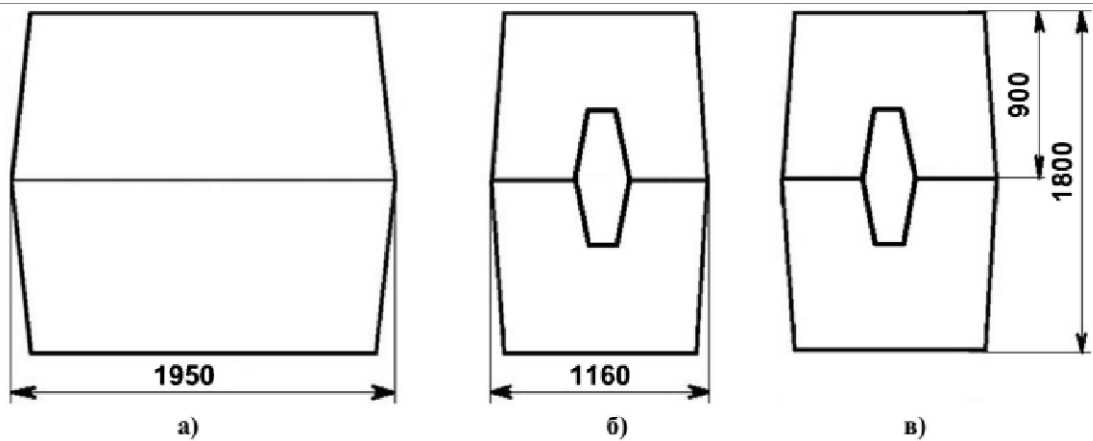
Габаритные размеры колодца «ККСр-3-80»: а - вид сбоку; б и в – виды с торца.
